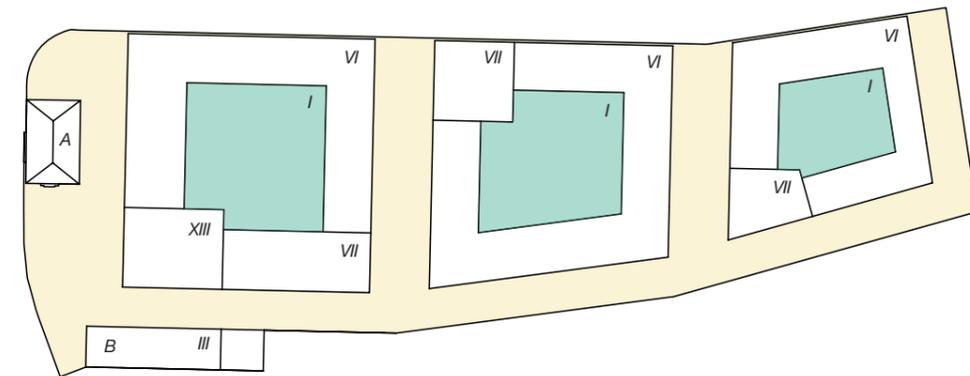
Schematischer Lageplan (ohne Maßstab)
